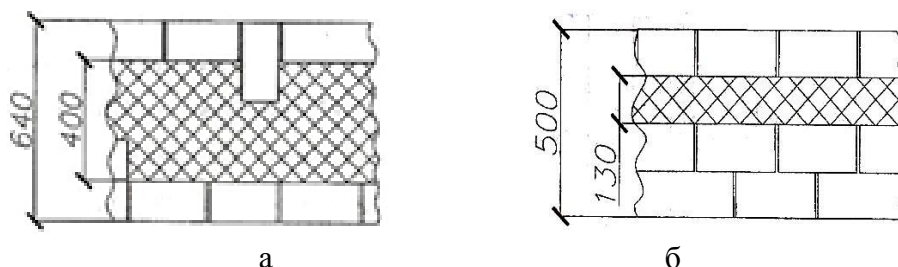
Конструкция стены из шлакобетонного камня с утеплителем из пенобетона (а) и минеральной ваты (б)
